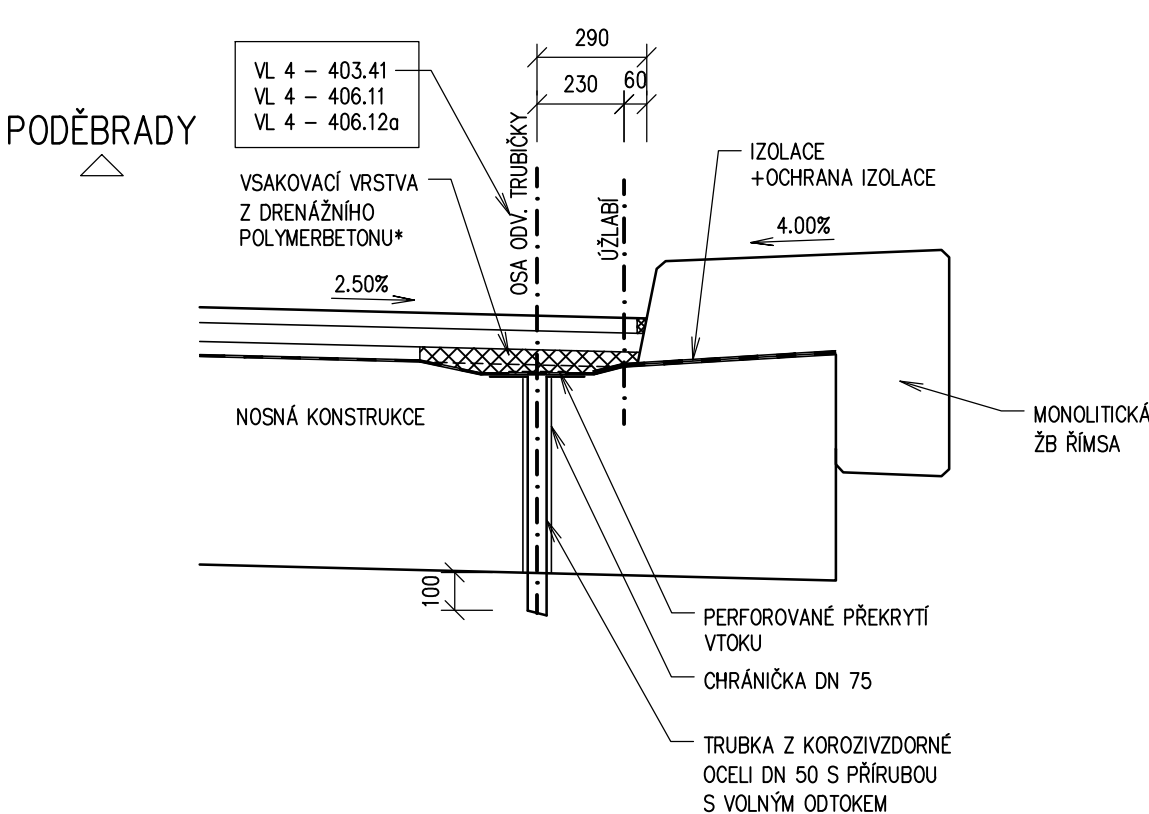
DETAIL ODVODNĚNÍ IZOLACE M 1:20
